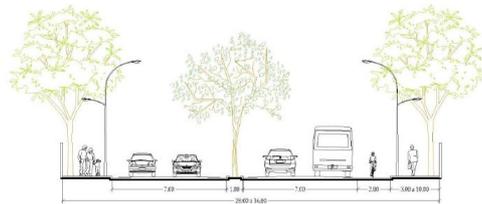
Perfil viário Rua 01 - Via Arterial (Fonte: MDE 109/20)
